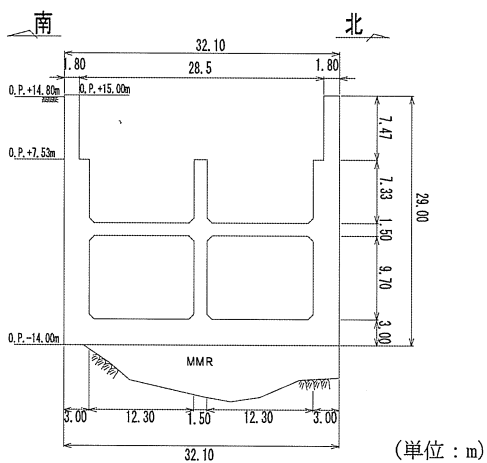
第 3 号機海水ポンプ室断面図 (B-B 断面)
